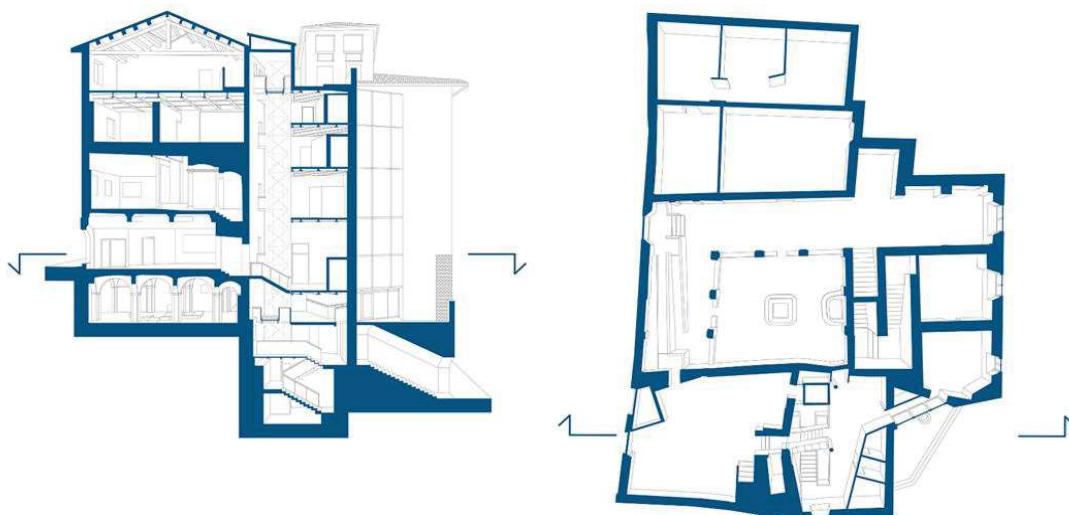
Sezione e pianta prospettica dell'edificio della Pinacoteca
